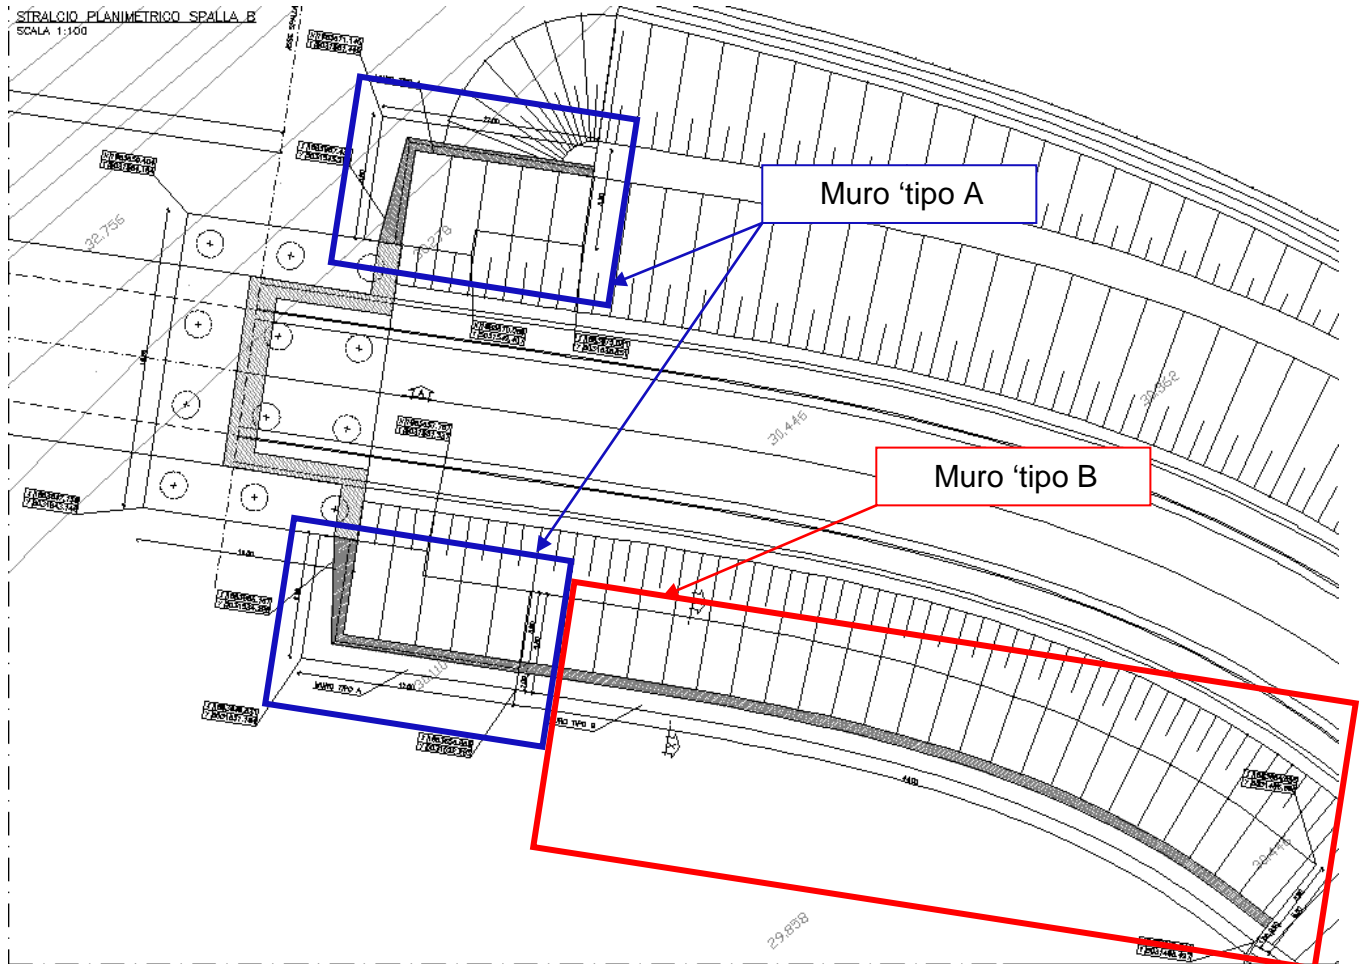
Stralcio planimetrico: ubicazione muri in c.a. lato spalla A
